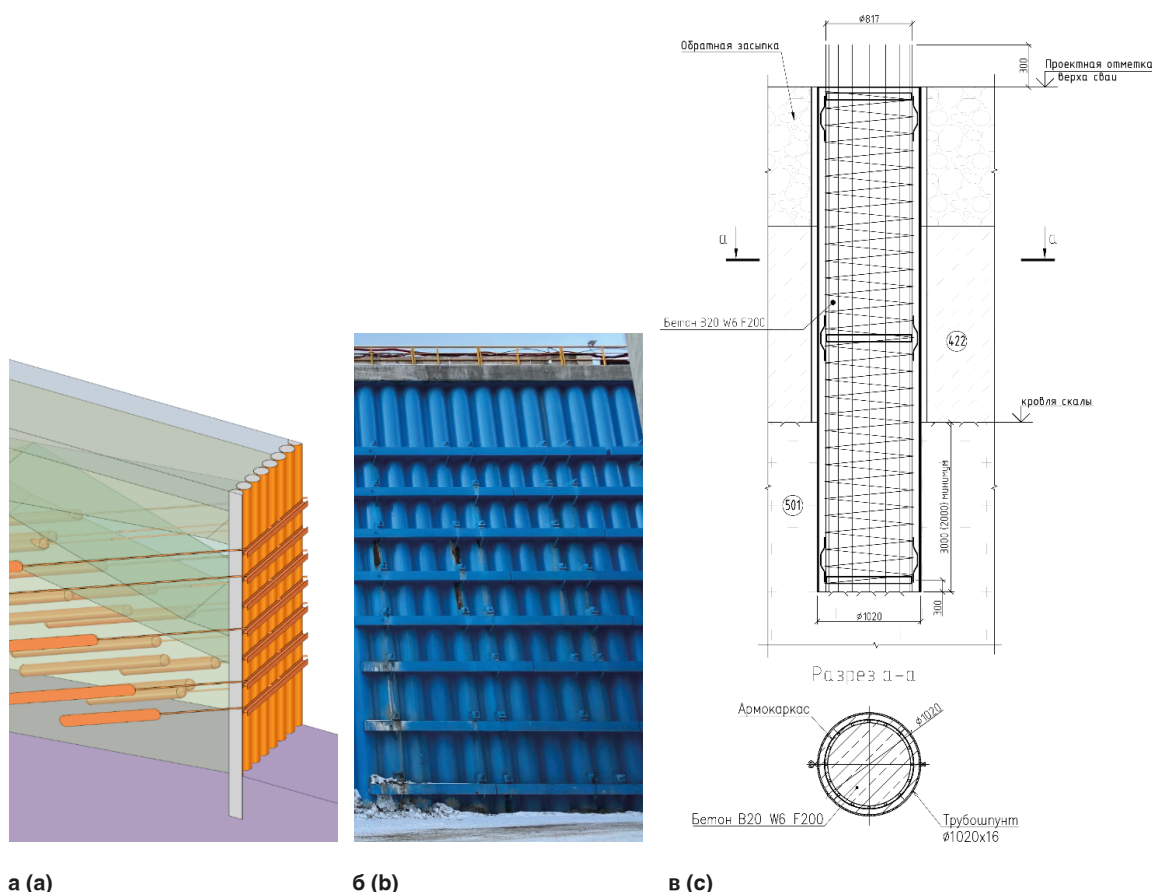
Шпунтовая стена сухого дока: а – вид модели заанкеренной шпунтовой стены; б – фотография лицевой грани шпунтовой стены; в – конструкция трубошпунта
